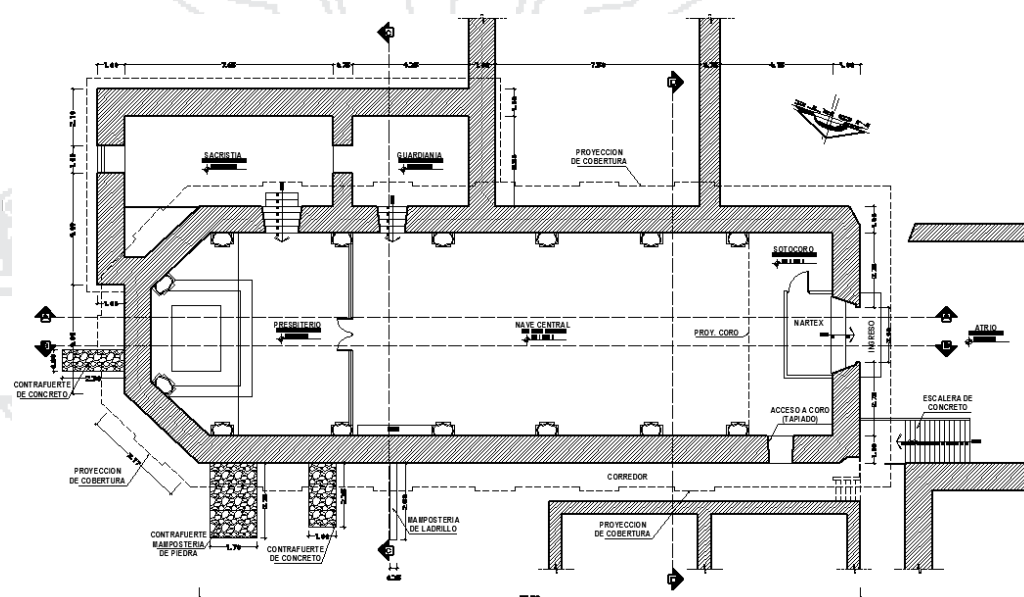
Planta arquitectónica Principal de la Capilla.
